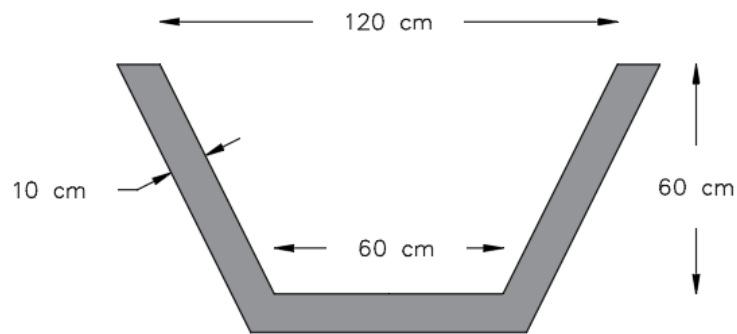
Sección canal trapezoidal (Terraza 1)
